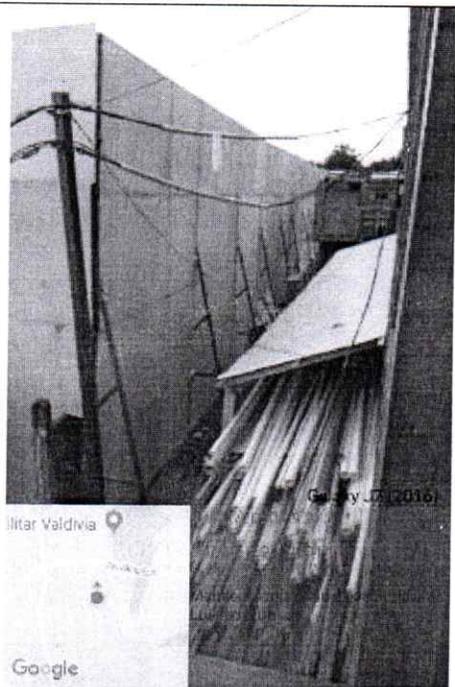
FOTO AEREA DE PERIMETRO ORIENTE /SUR
